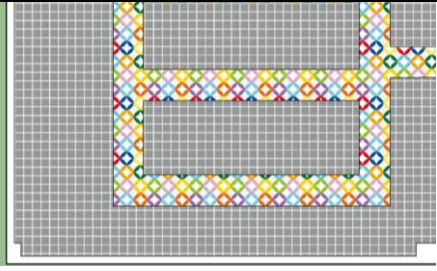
Alternatif Desain Lantai Ruang Tutor
